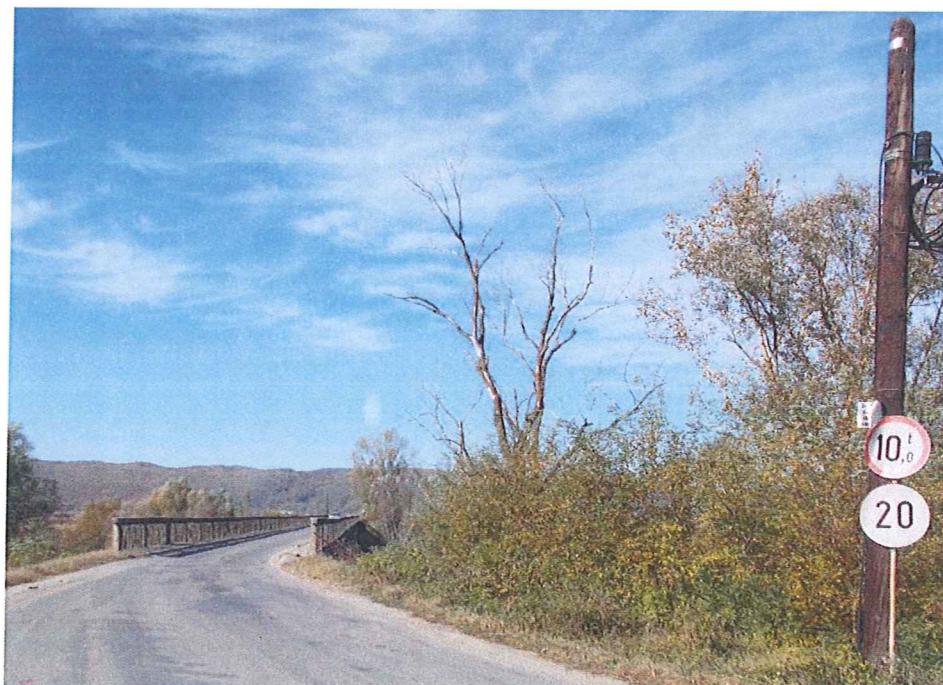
Vedere ansamblu cale - acces pe pod (mal drept - Năpradea)
